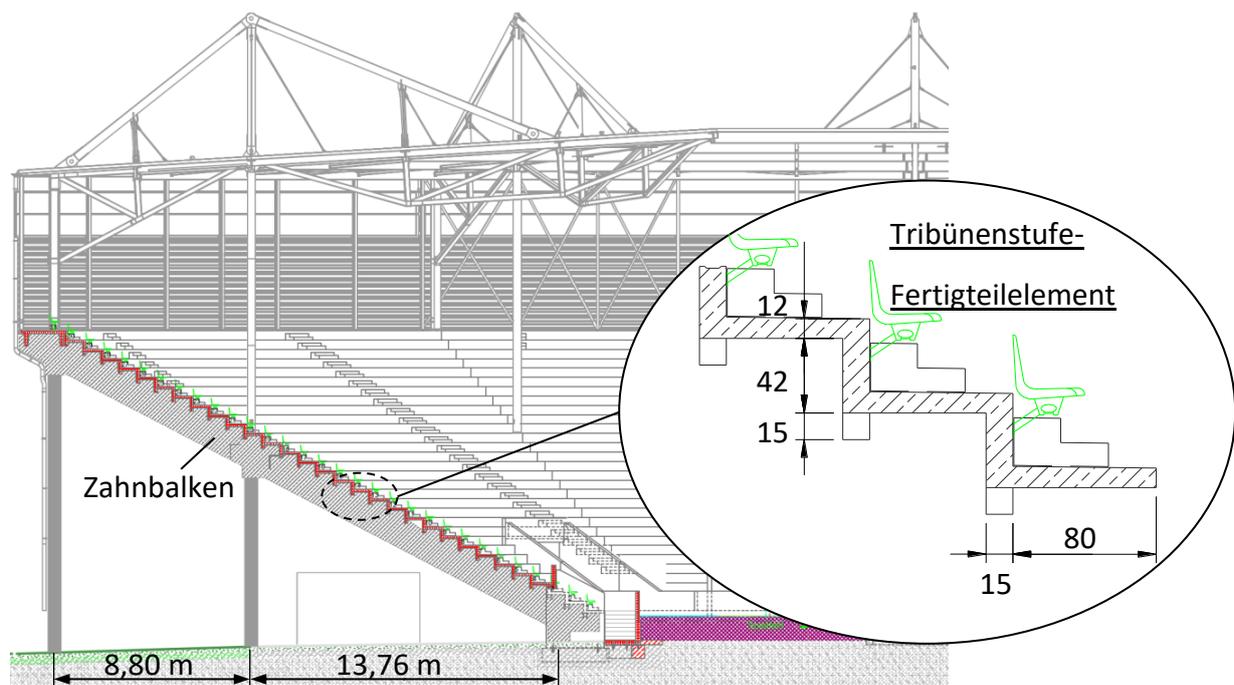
Tribünenkonstruktion der MDCC-Arena Magdeburg
